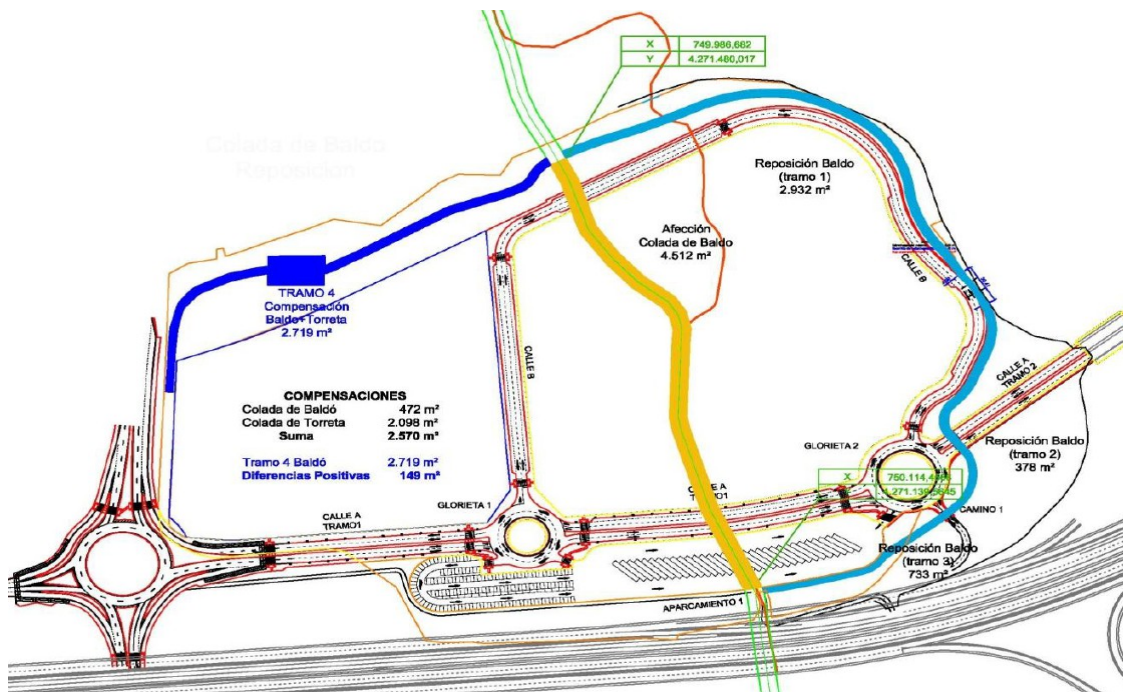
Afección (en amarillo) y propuesta de reposición y modificación de trazado (en azul) de la Colada de Baldó
